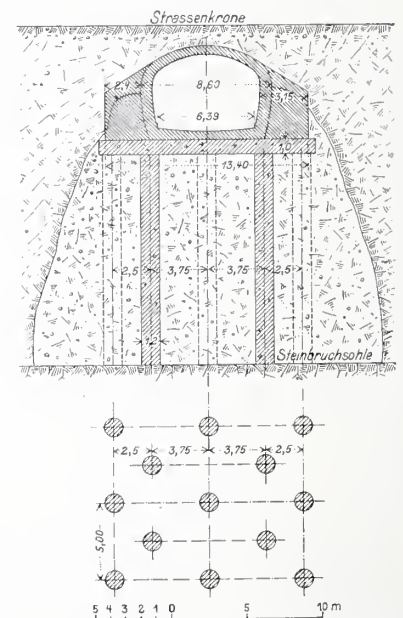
Tunnel über einem Steinbruch mit eingesunkener Decke. — 1:500.
